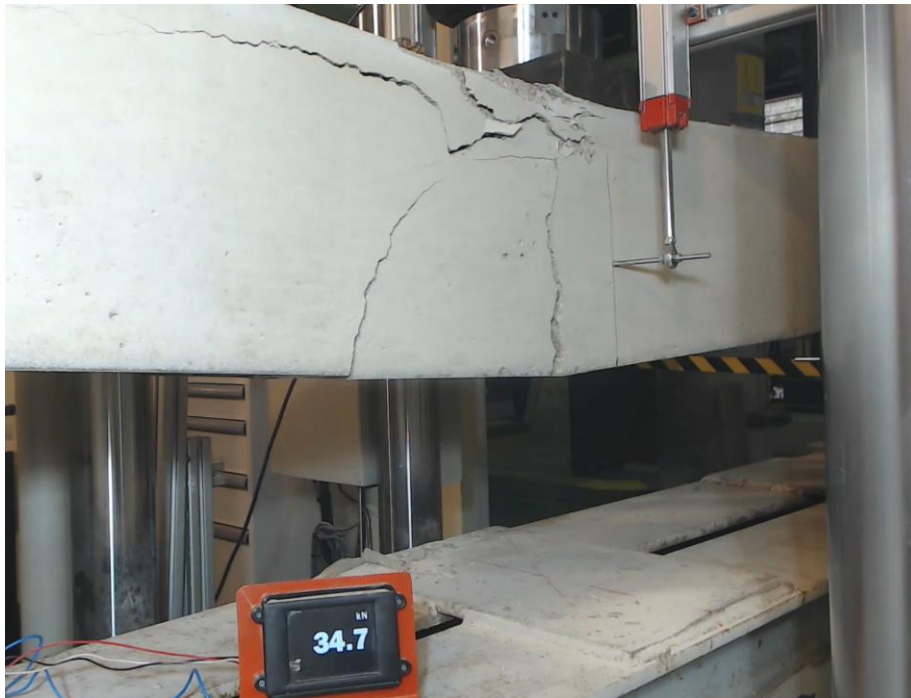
Fisuras Viga 3T13a a 34,7kN. Grupo 2.
